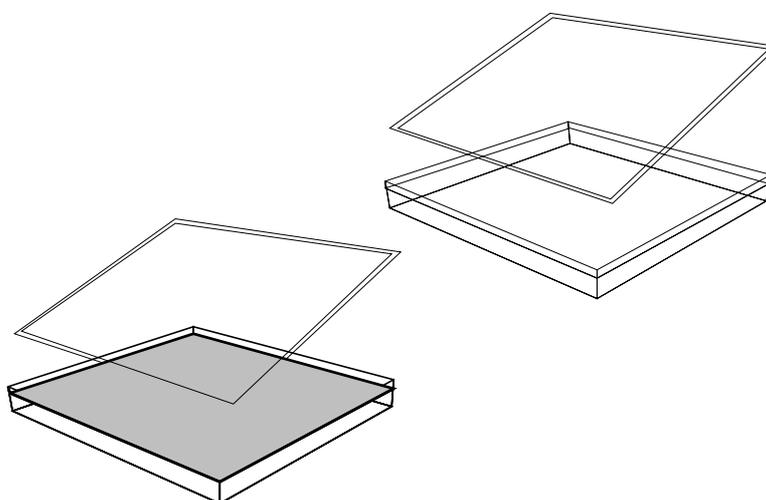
Prinzipielle 3-D-Ansicht der Flachdach-Fundationsschalen SOLight; rechte obere Fundationsschale ist schematisch leer dargestellt, die linke untere schematisch mit Dachkies aufgefüllt
